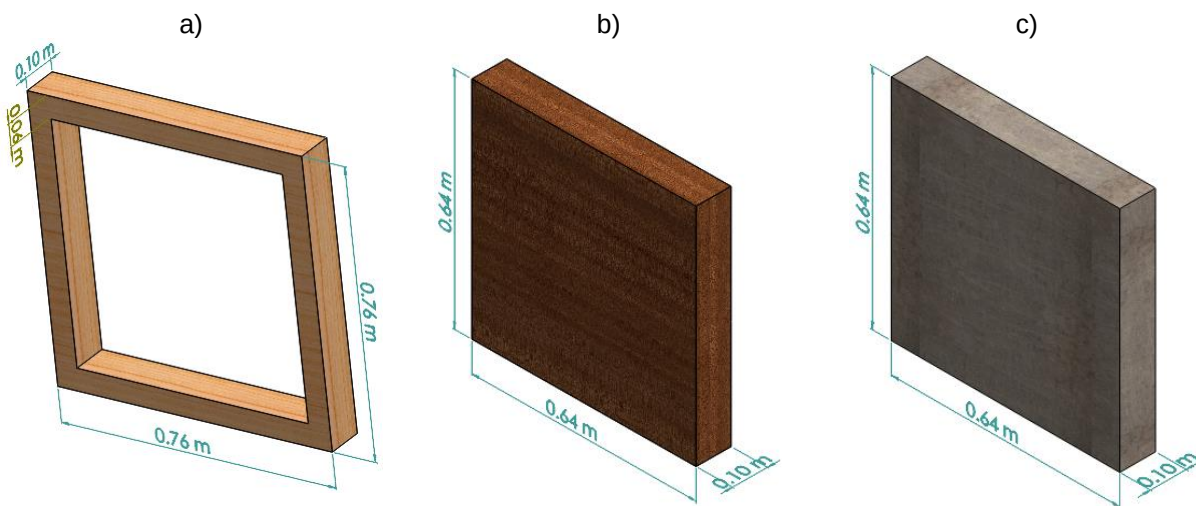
Componentes del arreglo experimental: a) marco estructural para los muros, b) muro del material a base de *pak'luum*, c) muro de bloques huecos de concreto.
